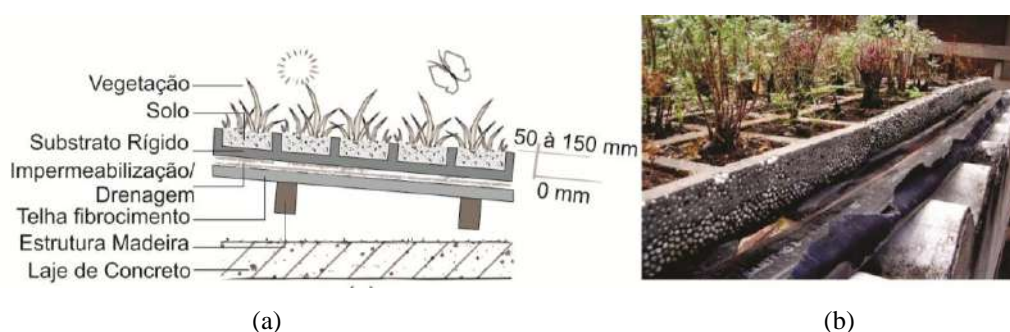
(a) Detalhe das camadas de telhado vegetado extensivo e (b) Telhado Vegetado extensivo em Cuiabá-MT/Brasil.
